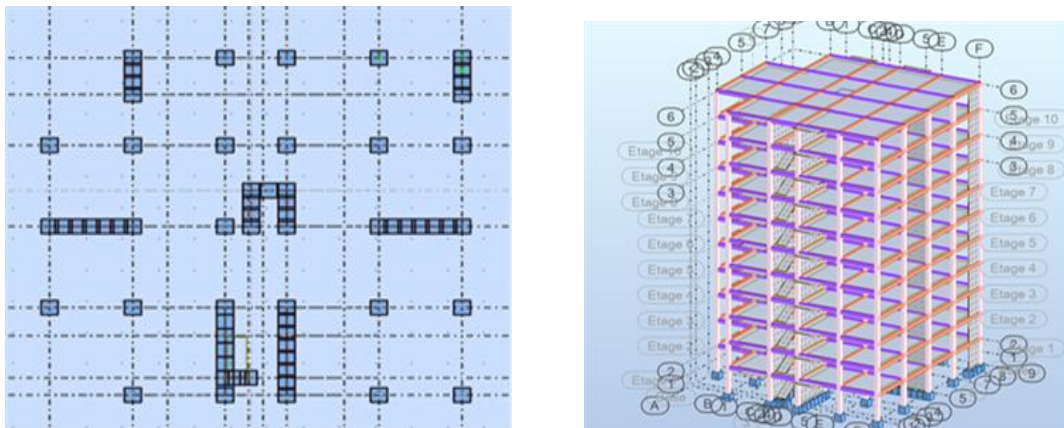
Vue en plan et en élévation de la 1 ère variante.
